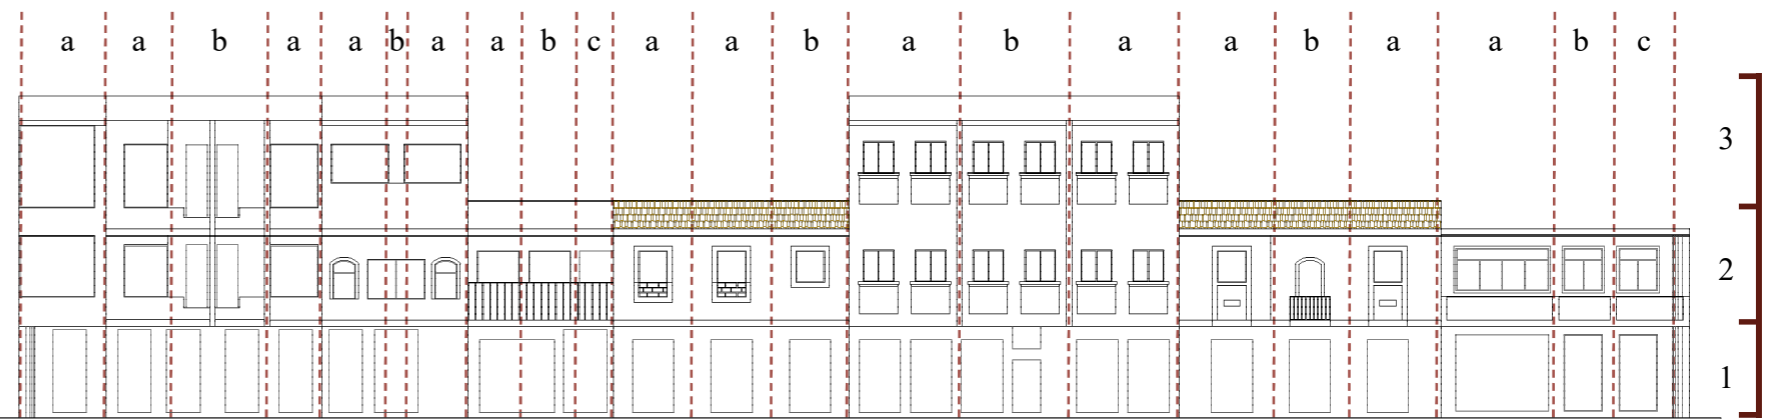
Análisis fachada este, tramo 2 calle Rocafuerte.
